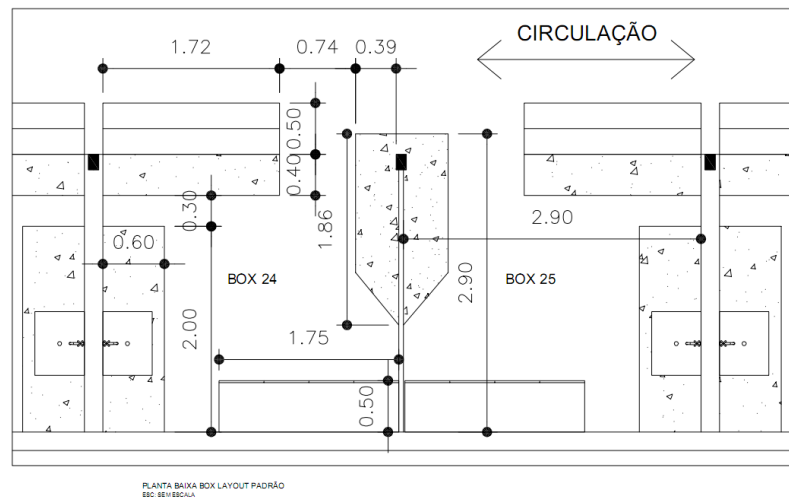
Planta Baixa com Layout do Box Padrão.
